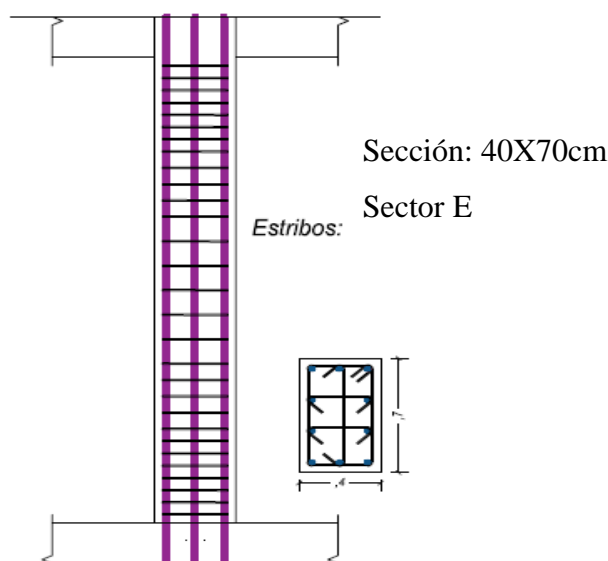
Detalle de Columna en Base Aislada (E)
